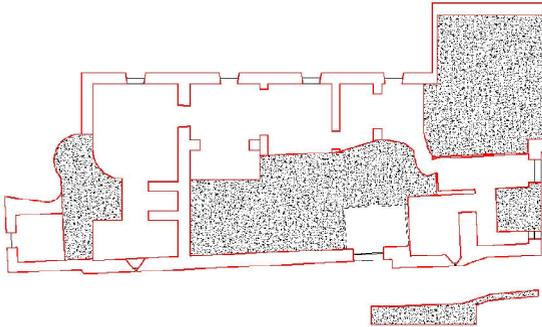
Possibile 2^a fase di costruzione dell'ospitale: pianta e prospetto.
